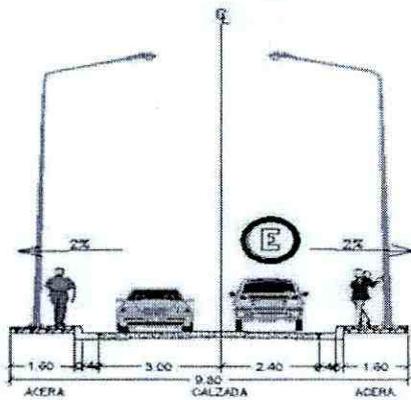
Sección transversal vía local unidireccional con estacionamiento en ambos laterales
